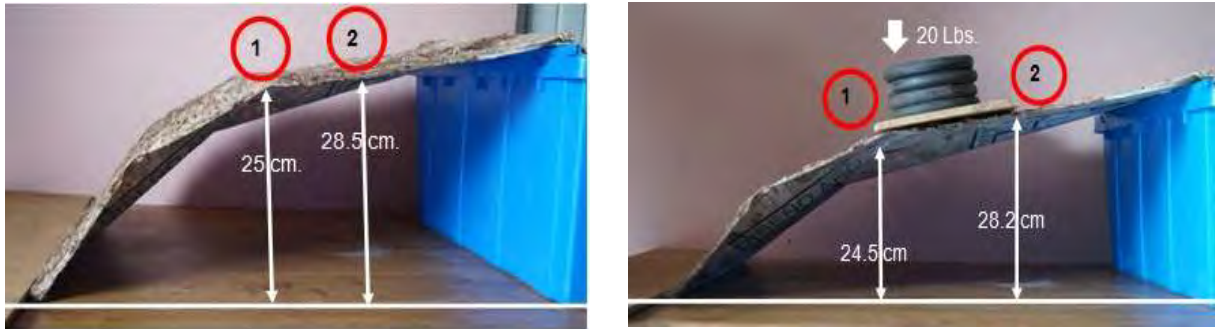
Cubierta fija, al inicial las pruebas y en el proceso de aplicación de carga.
